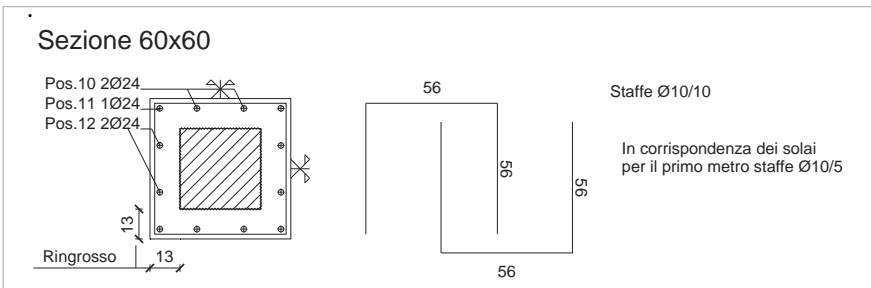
Particolare ringrosso sezione pilastro tipo
